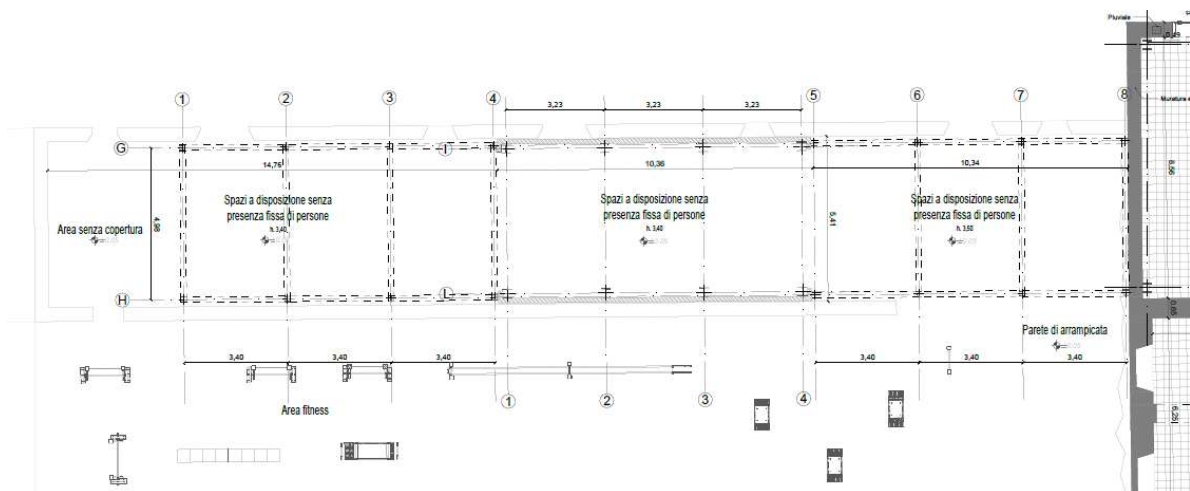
Ex-Galoppatoio - pianta piano terra Edificio 2
